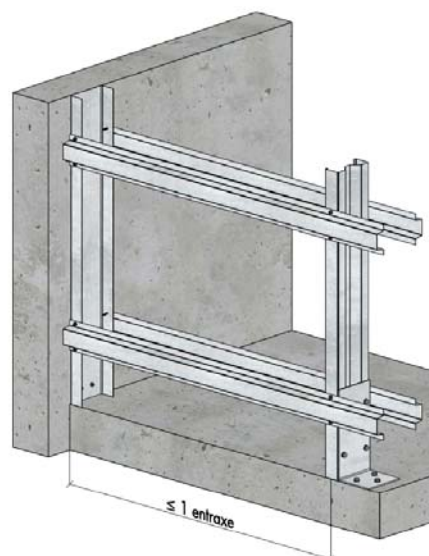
Dispositions au raccordement à une paroi verticale avec rail U
